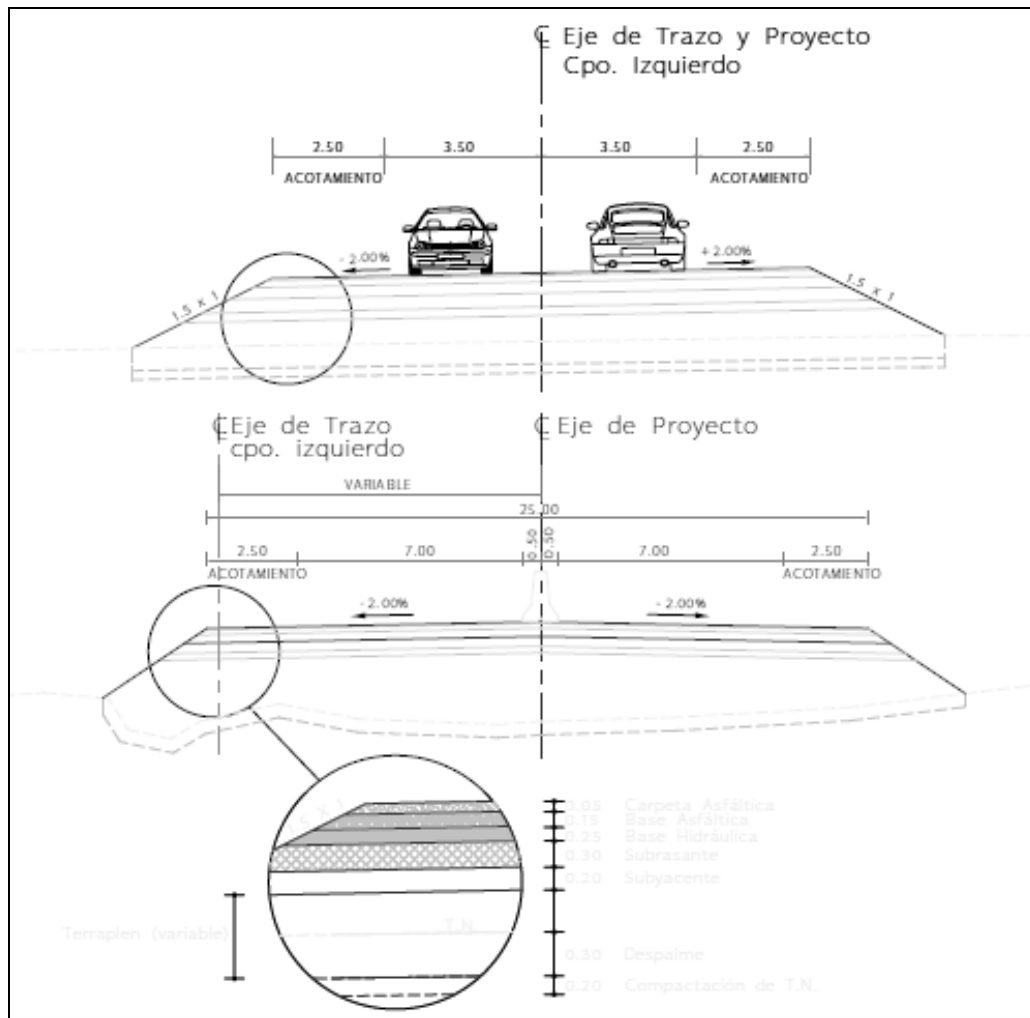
Sección tipo de la carretera y conformación de pavimentos.
